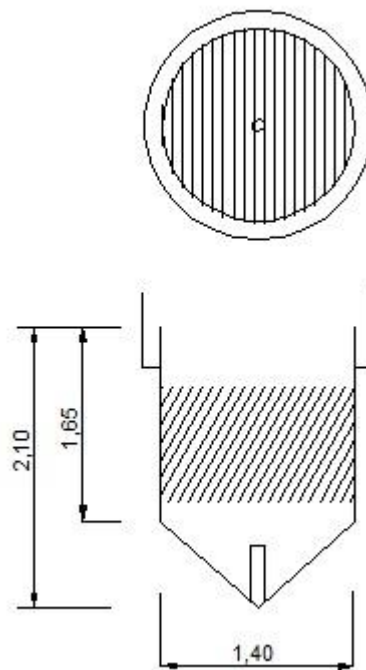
Corte e planta do decantador lamelar (medidas em metros)
